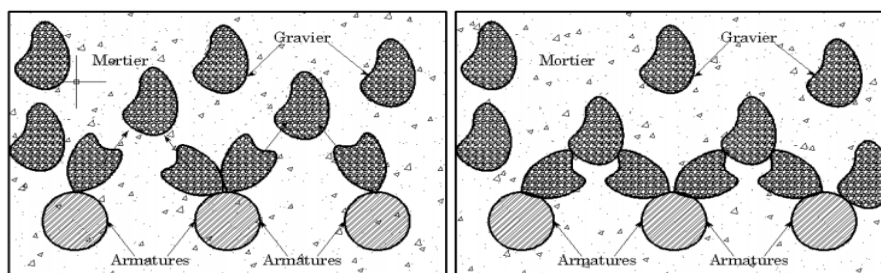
Représentation en plan d'un blocage de granulats à travers deux armatures [32].
